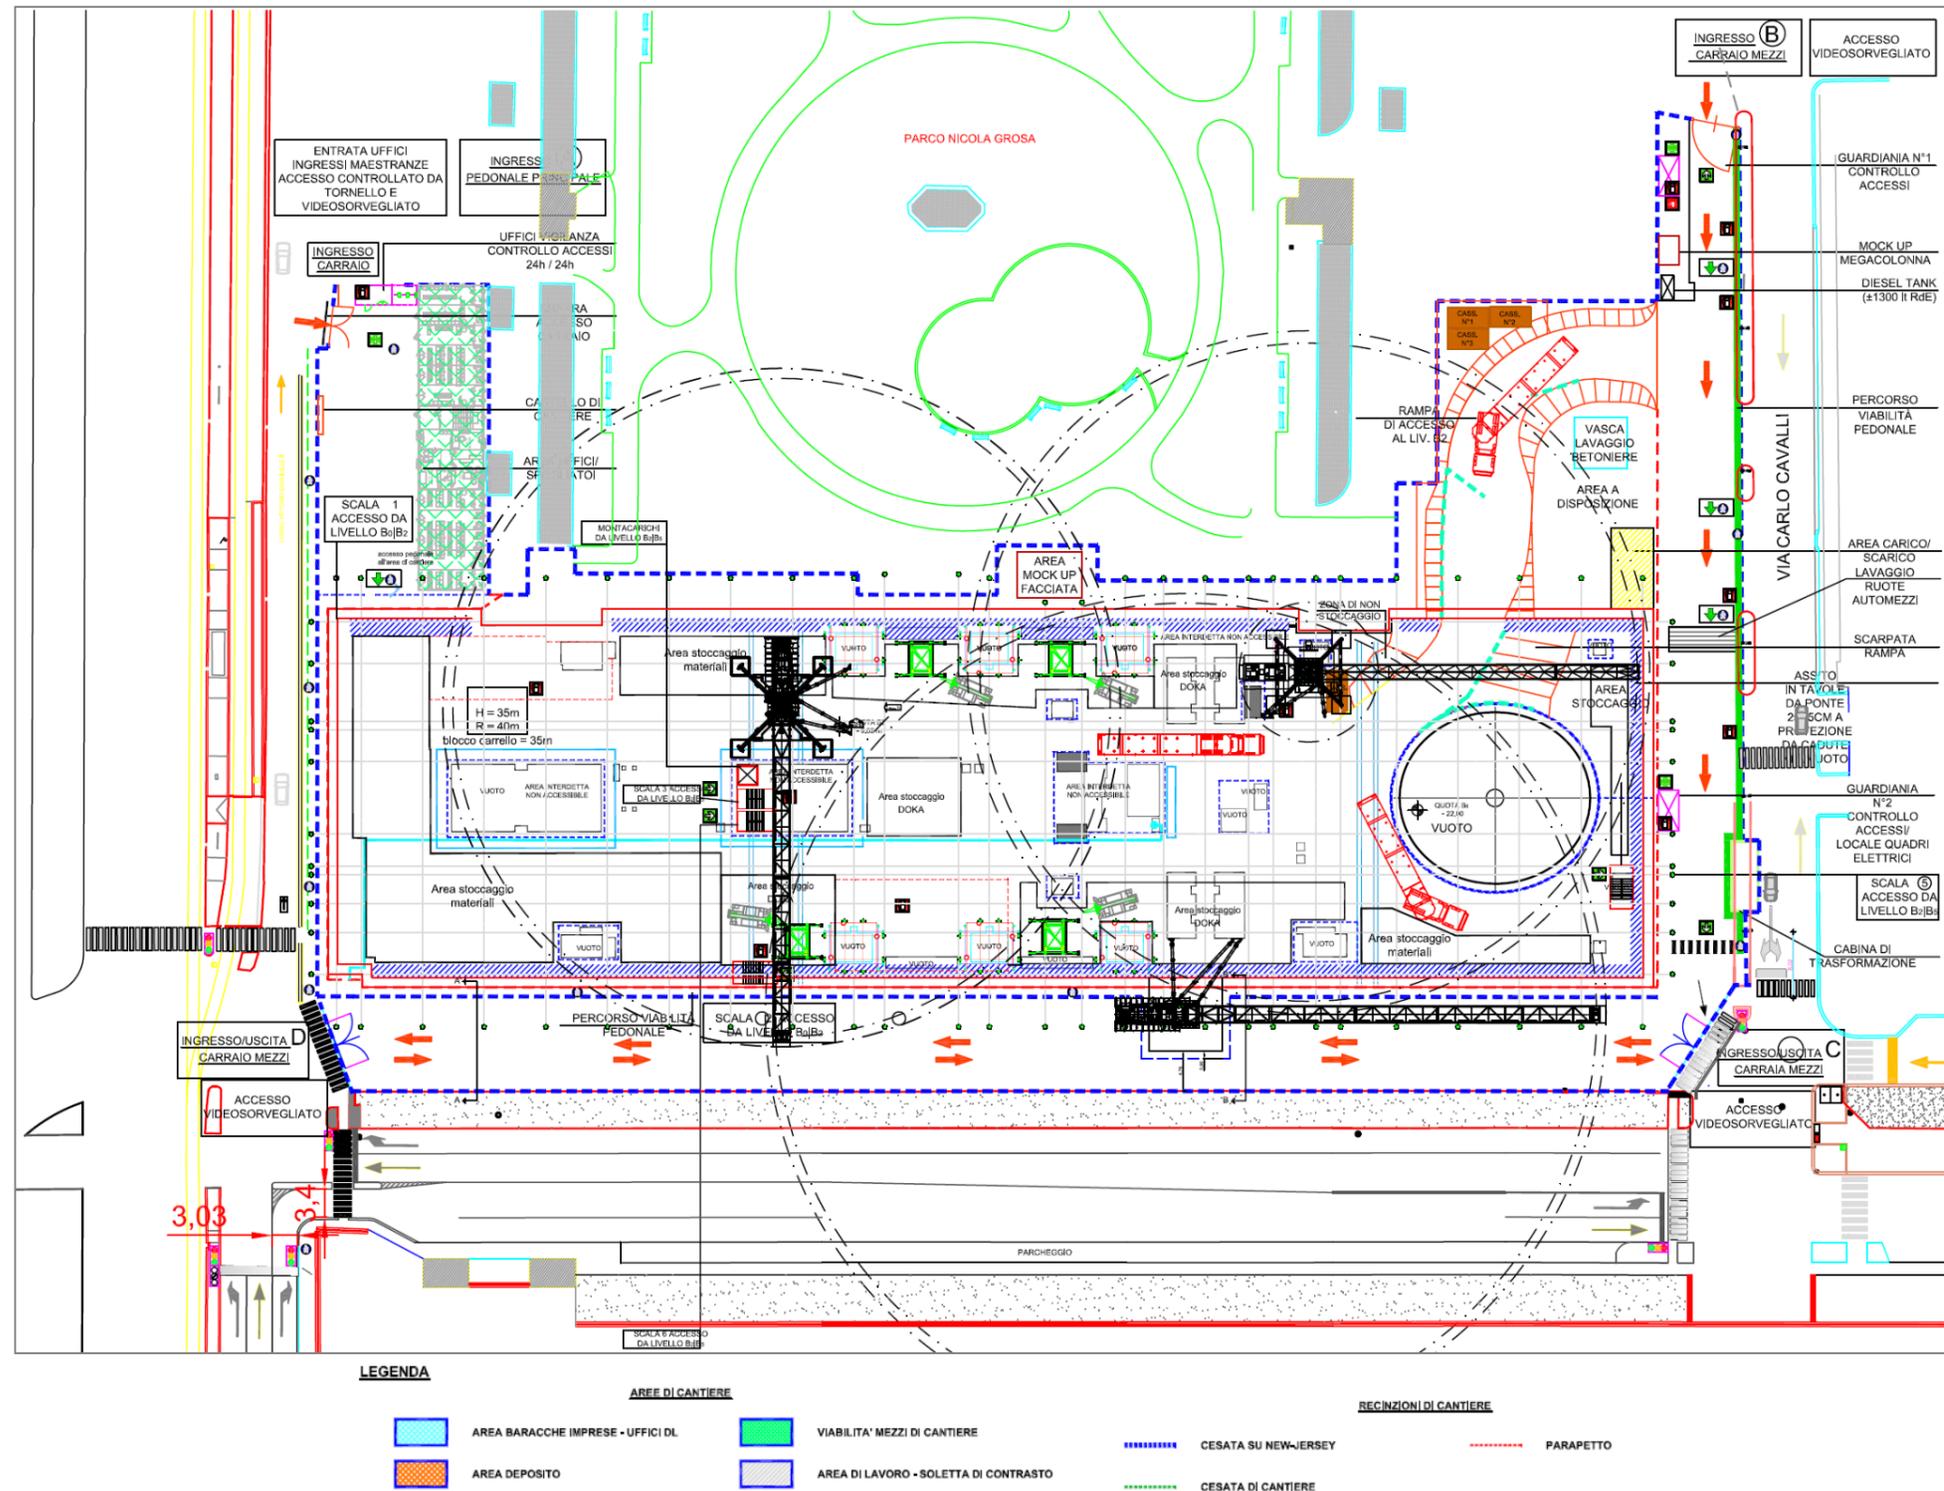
Planimetria di cantiere – aggiornata a Gennaio 2011 (fonte: da elaborazione Torre Scarl)
